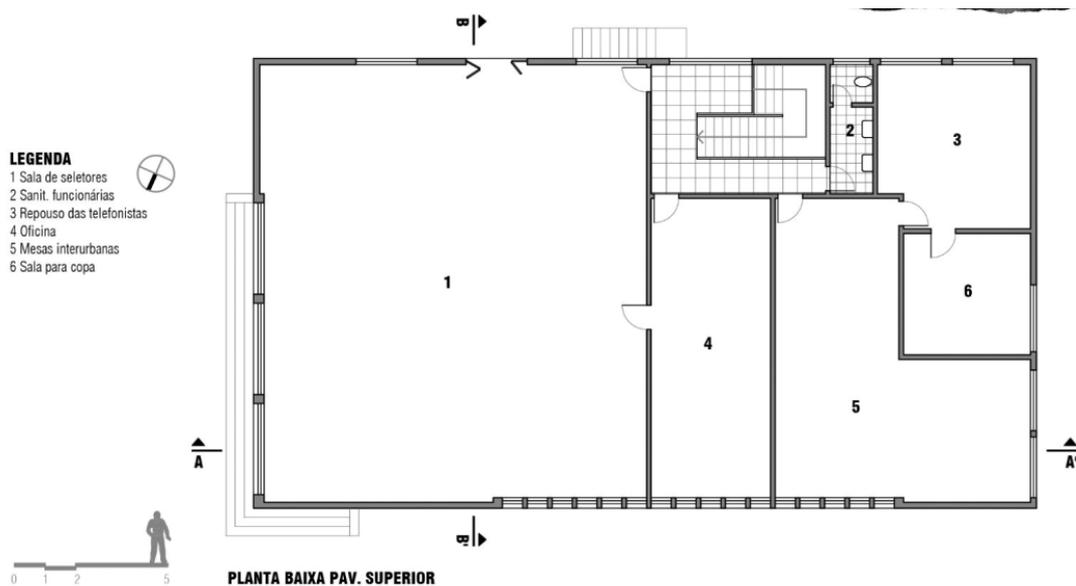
Planta Baixa do Pavimento Superior do Projeto da Cia Telefônica Municipal
